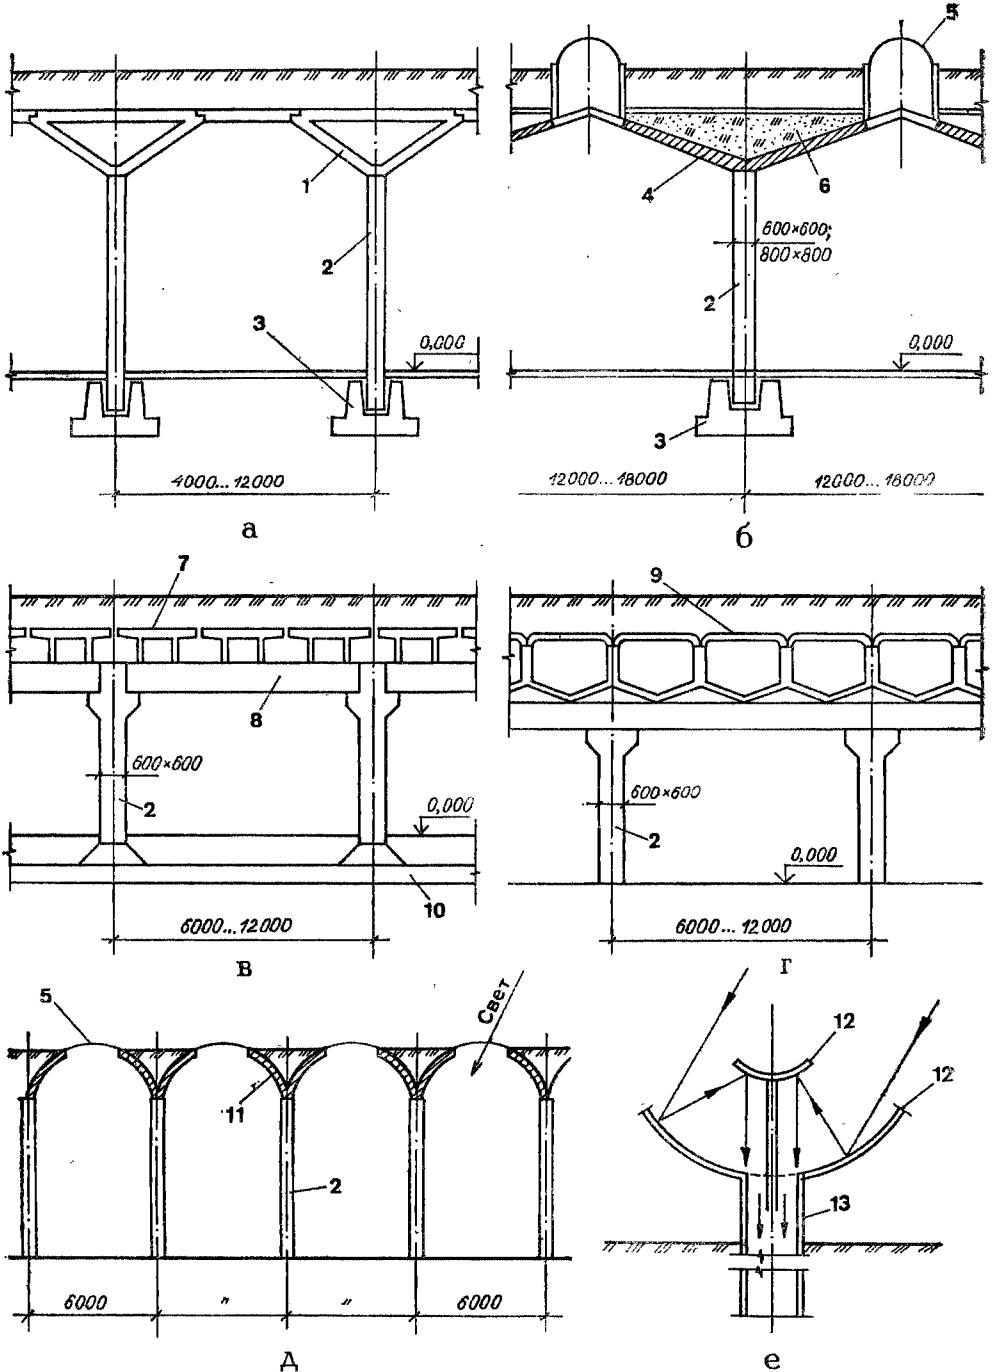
Конструкции многопролетных одноэтажных зданий:
